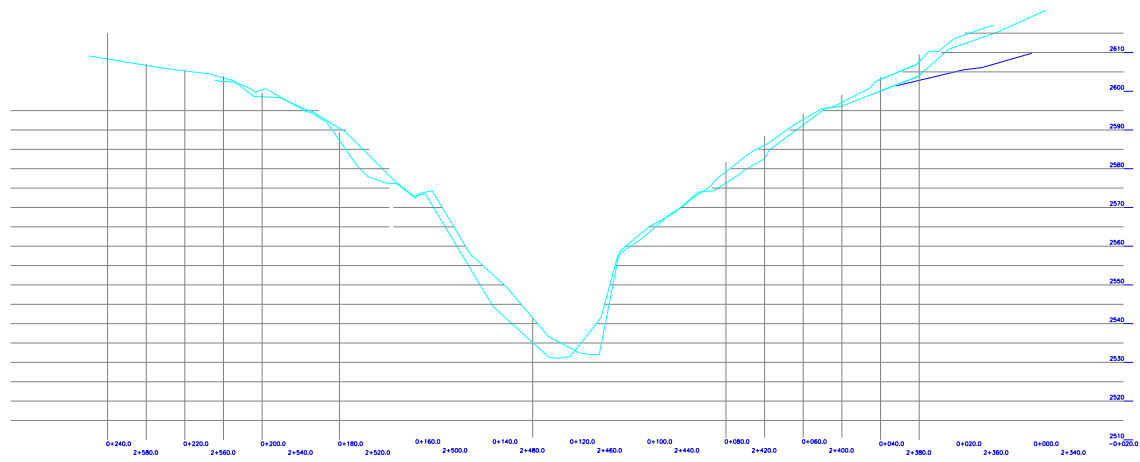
Perfiles transversales de la quebrada de Gualo para donde se diseñará el puente.
